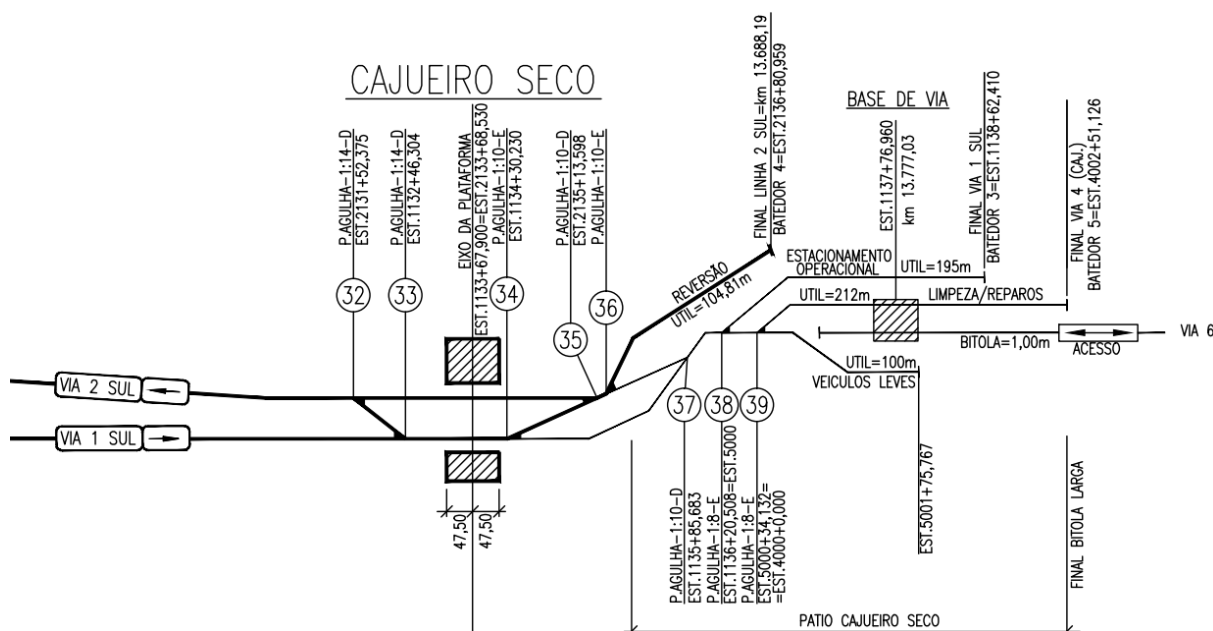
Plano Esquemático de Vias do Pátio de Cajueiro Seco
